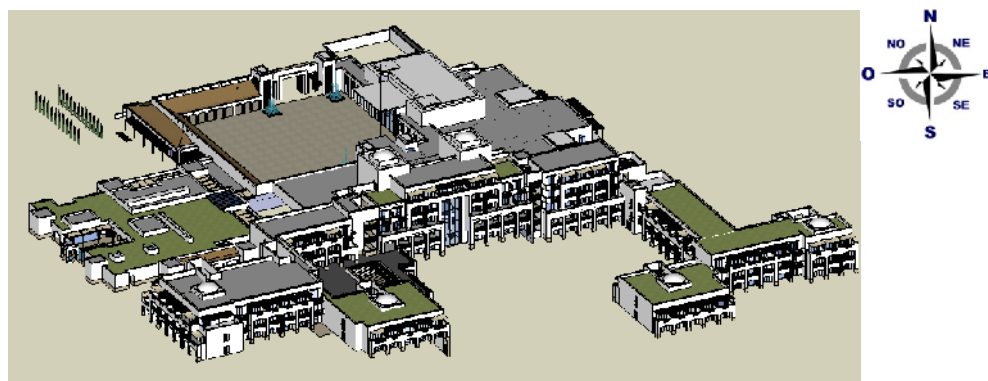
Vista da fachada principal em Perspectiva 3D
